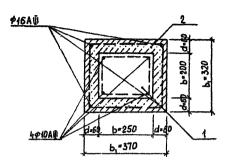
Рис. I. Сечение раскоса, усиленного обоймой. I - раскос фермы; 2 - железобетонная обойма.
